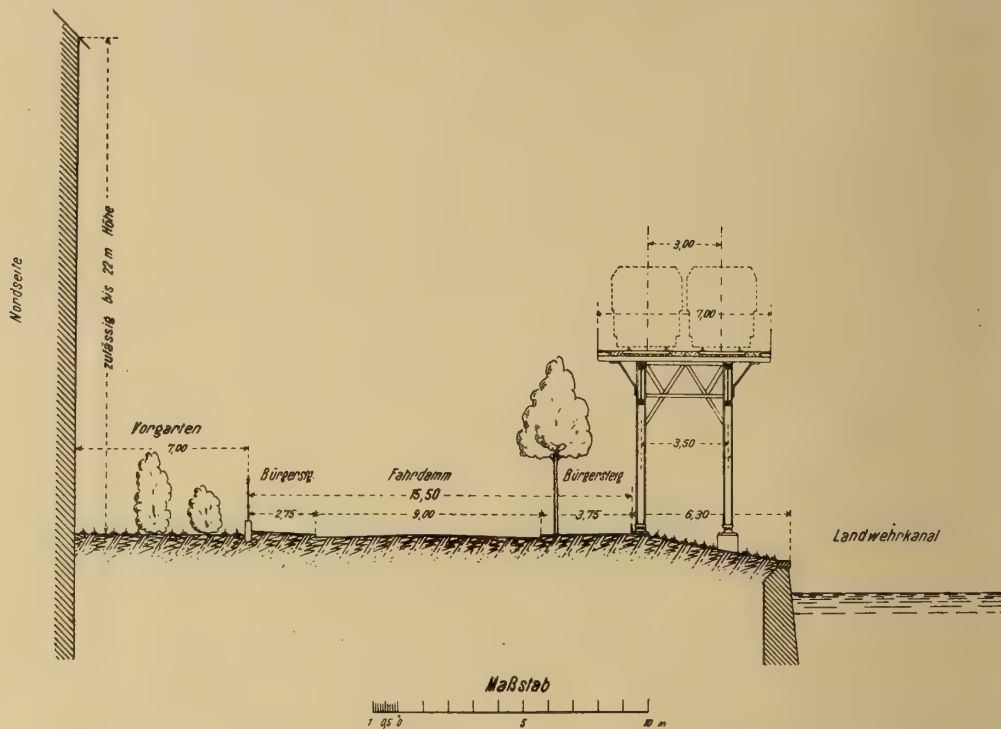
Hallesches Ufer mit Hochbahn.
